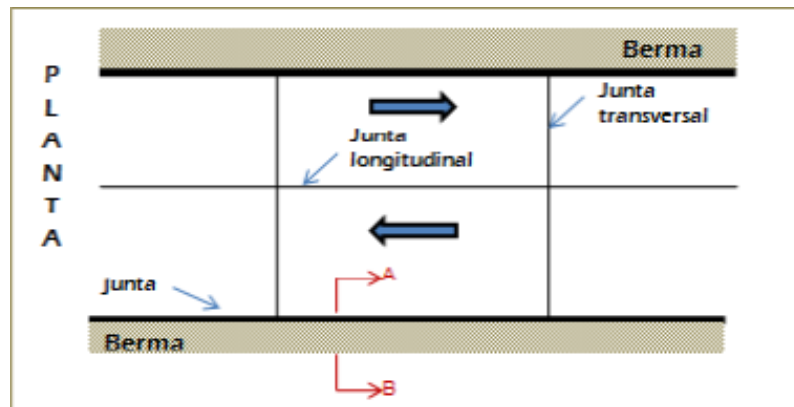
Esquema de la vista en planta del Desnivel Carril / Berma.
